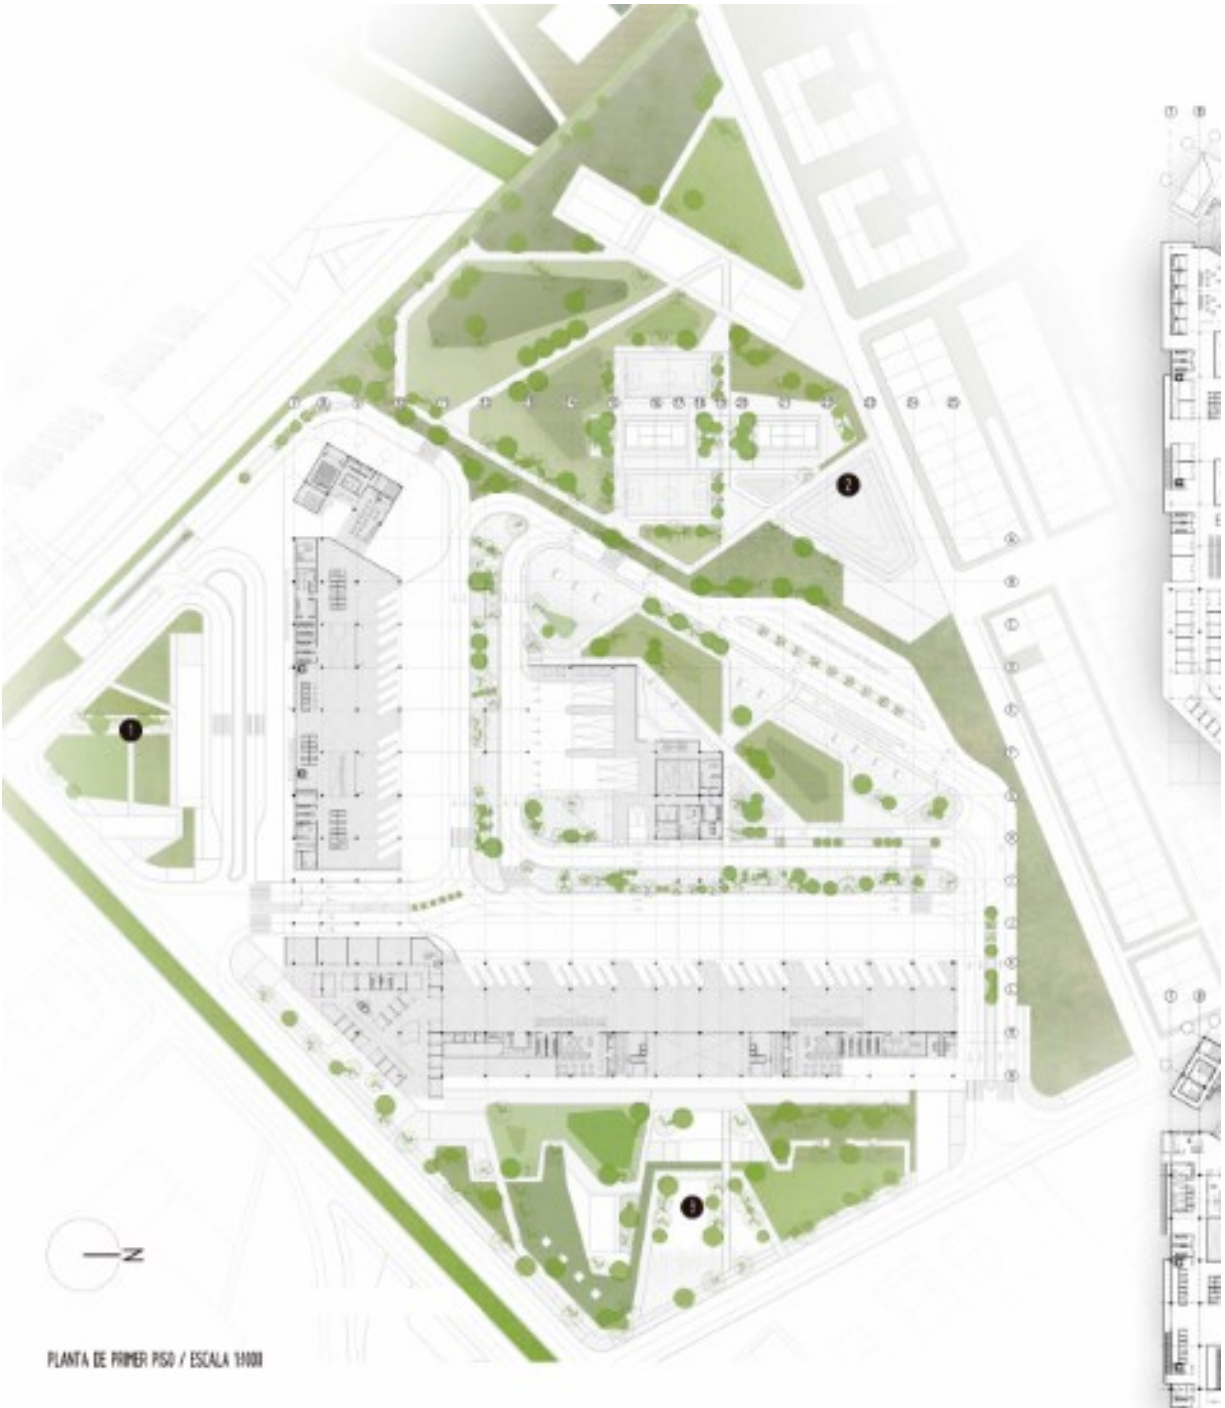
PLANTA ARQUITECTONICA PRIMER PISO ESC 1:1000
